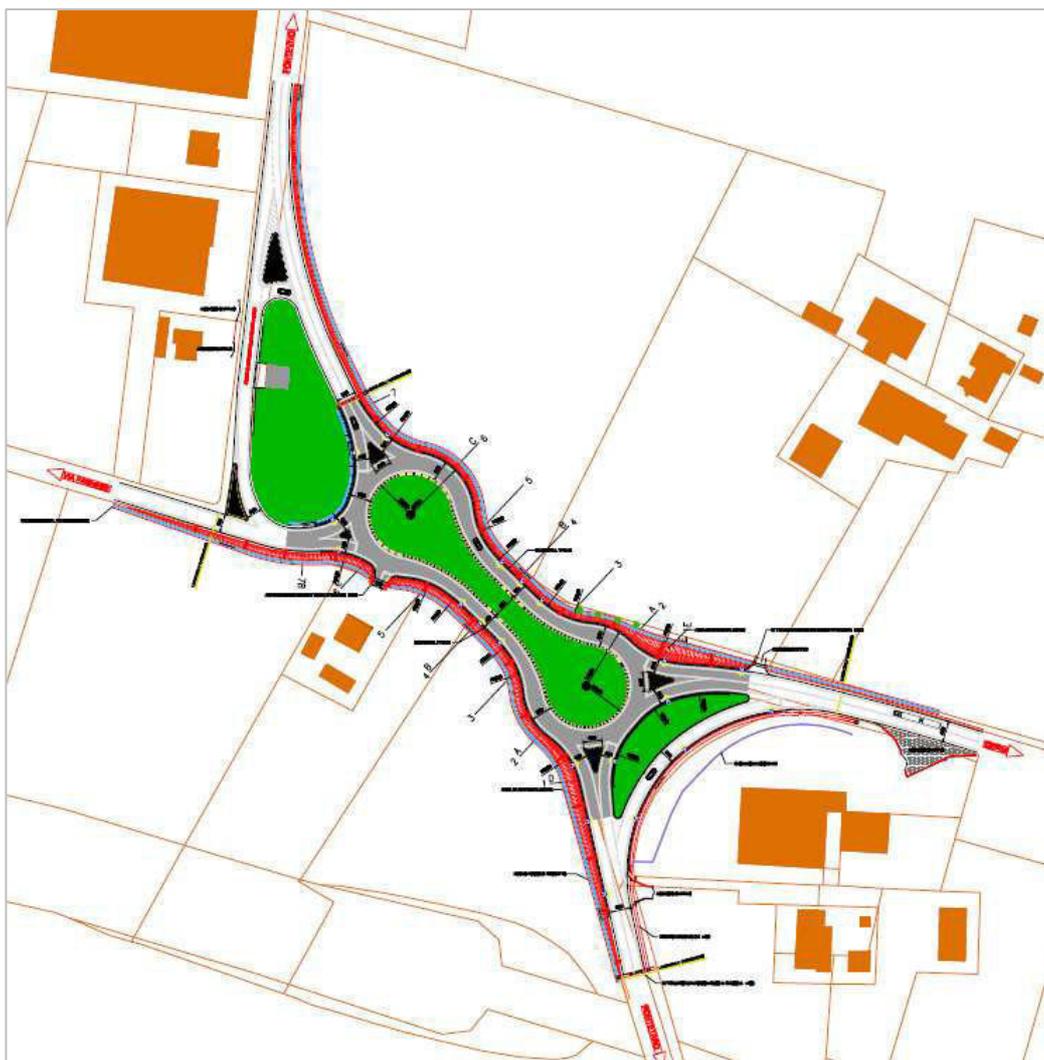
PLANIMETRIA DELLA ROTATORIA
